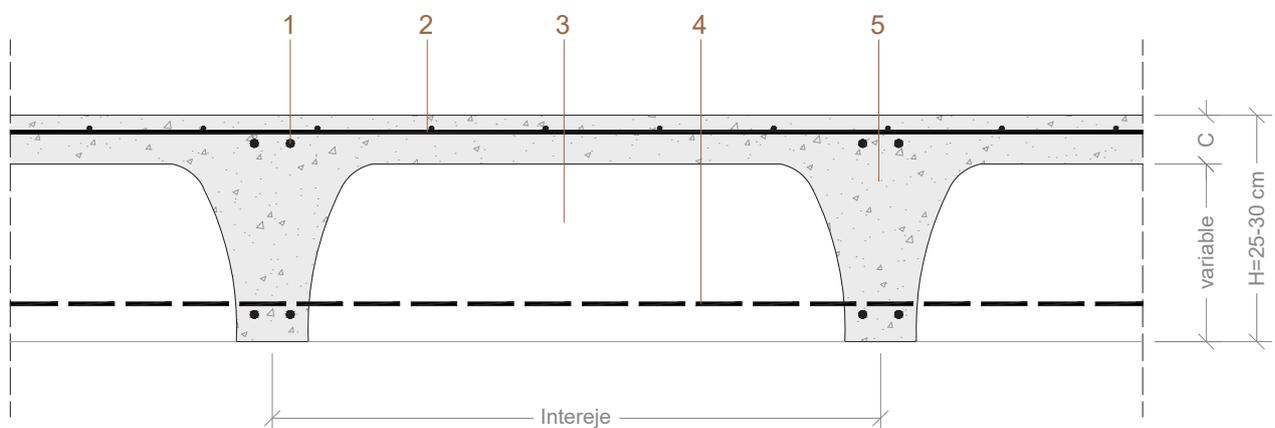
Sección tipo de forjado reticular con bloque aligerante recuperable
